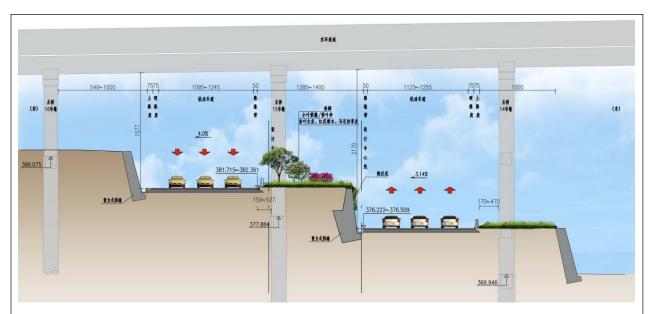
道路绿化标准横断面图 (5K+600~637 段)
